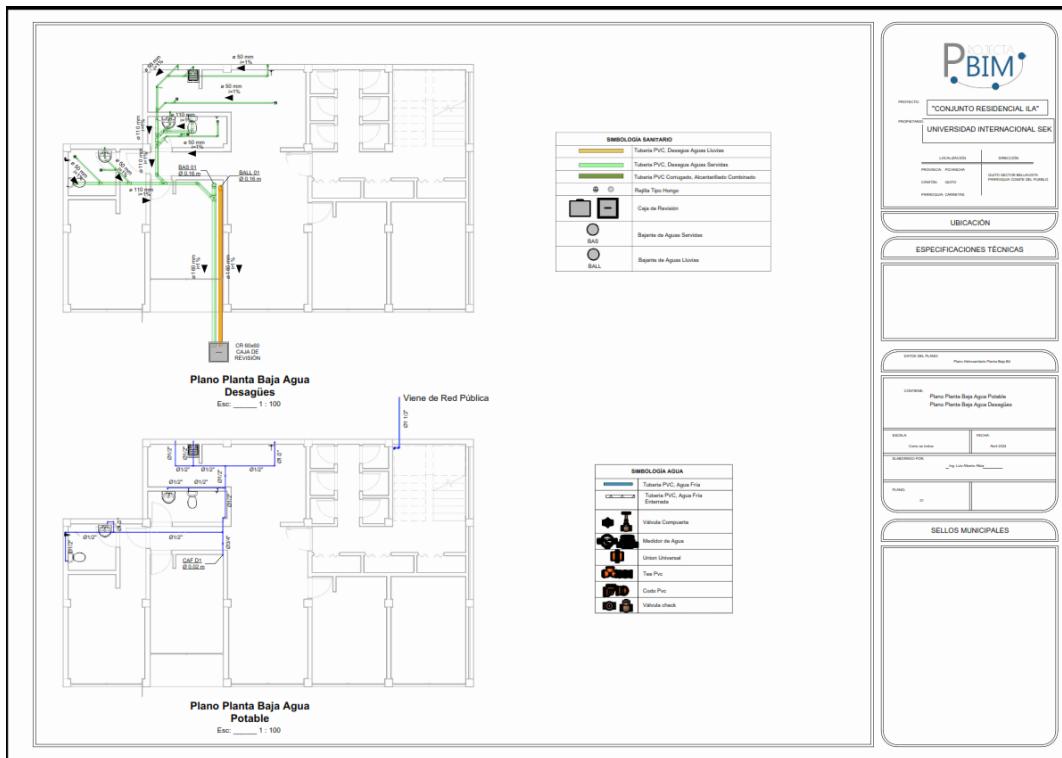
Plano Hidrosanitario Planta Baja B4
